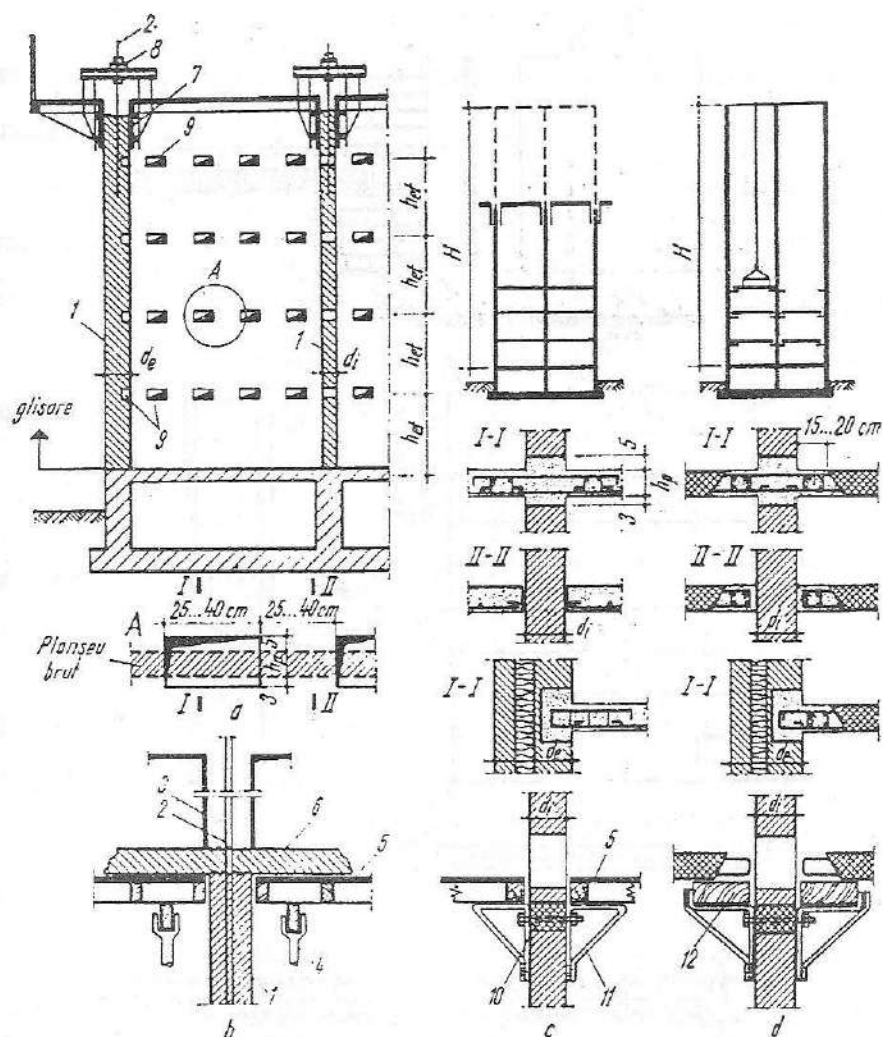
Planșee pentru structuri cu diafragme turnate în cofraje glisante:
